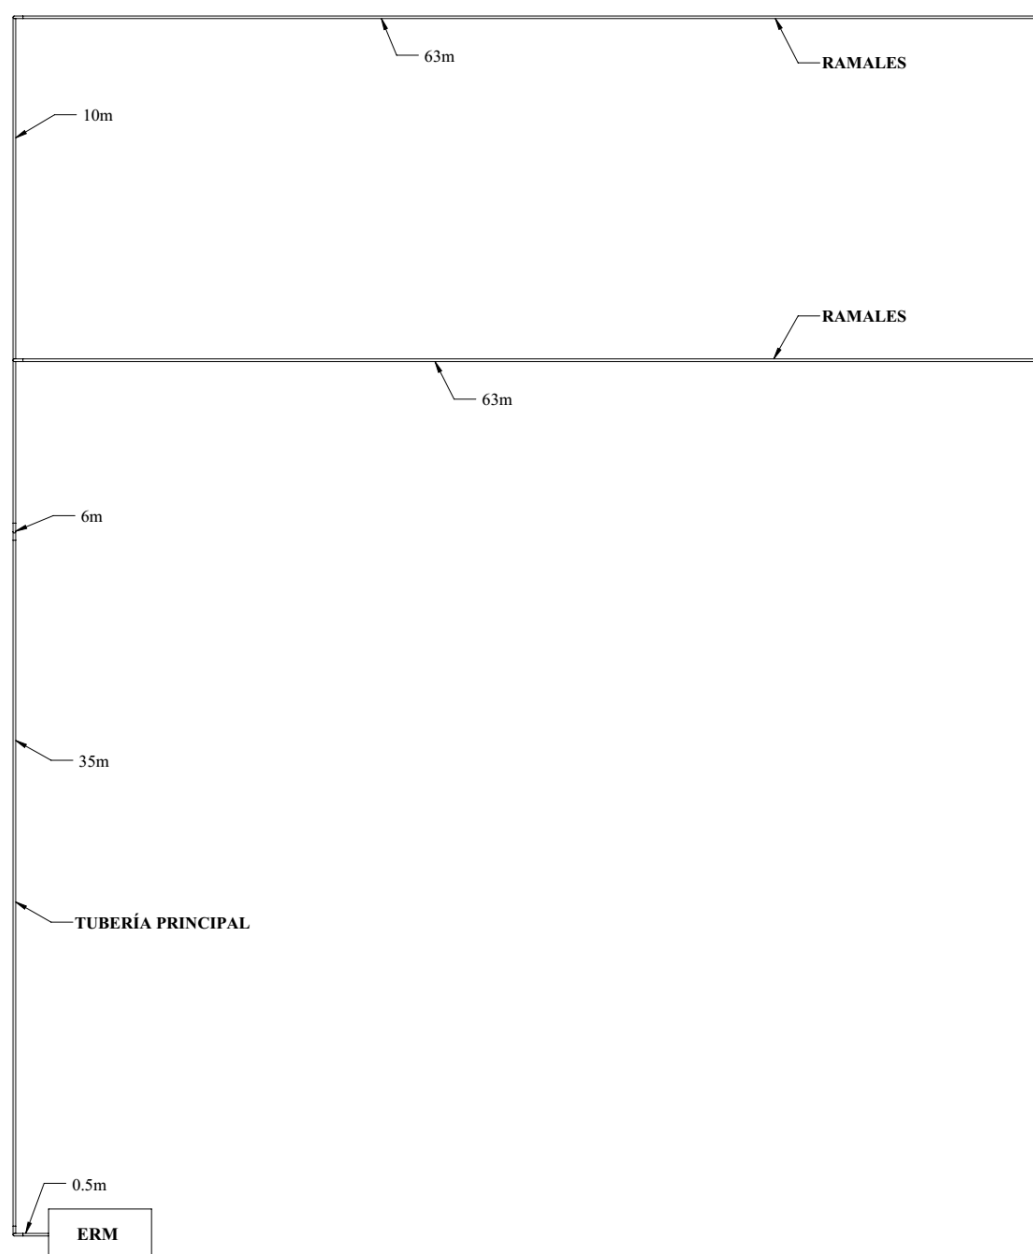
Layout de la instalación de tuberías de GNC –Vista superior
